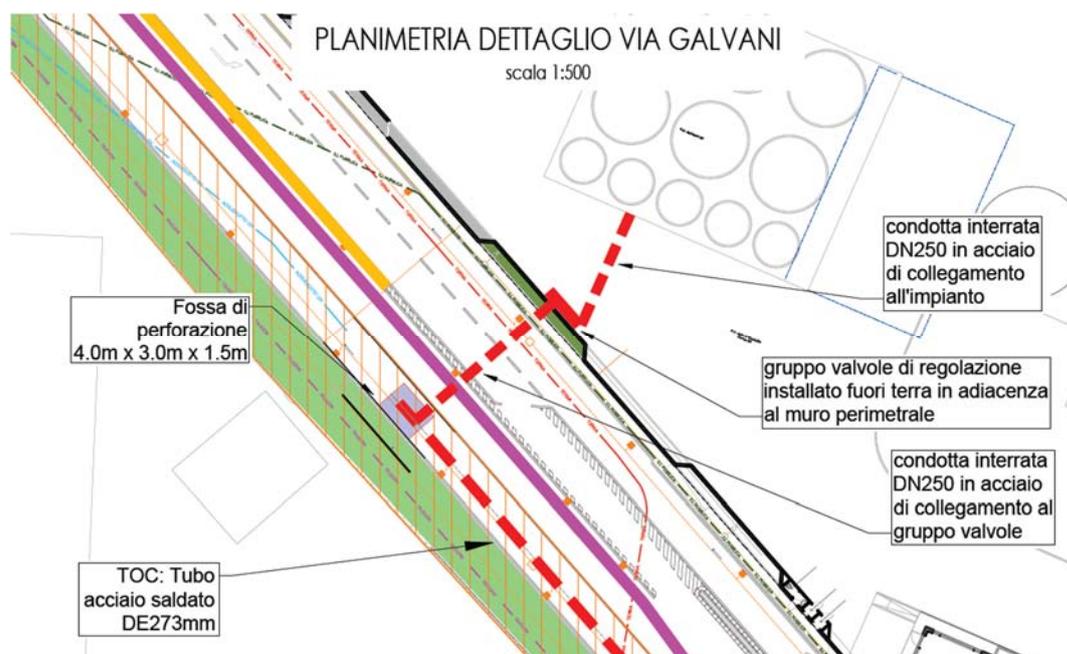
Cantiere lato Ovest — uscita TOC lato ovest - sito Banchina Molini, via Galvani
